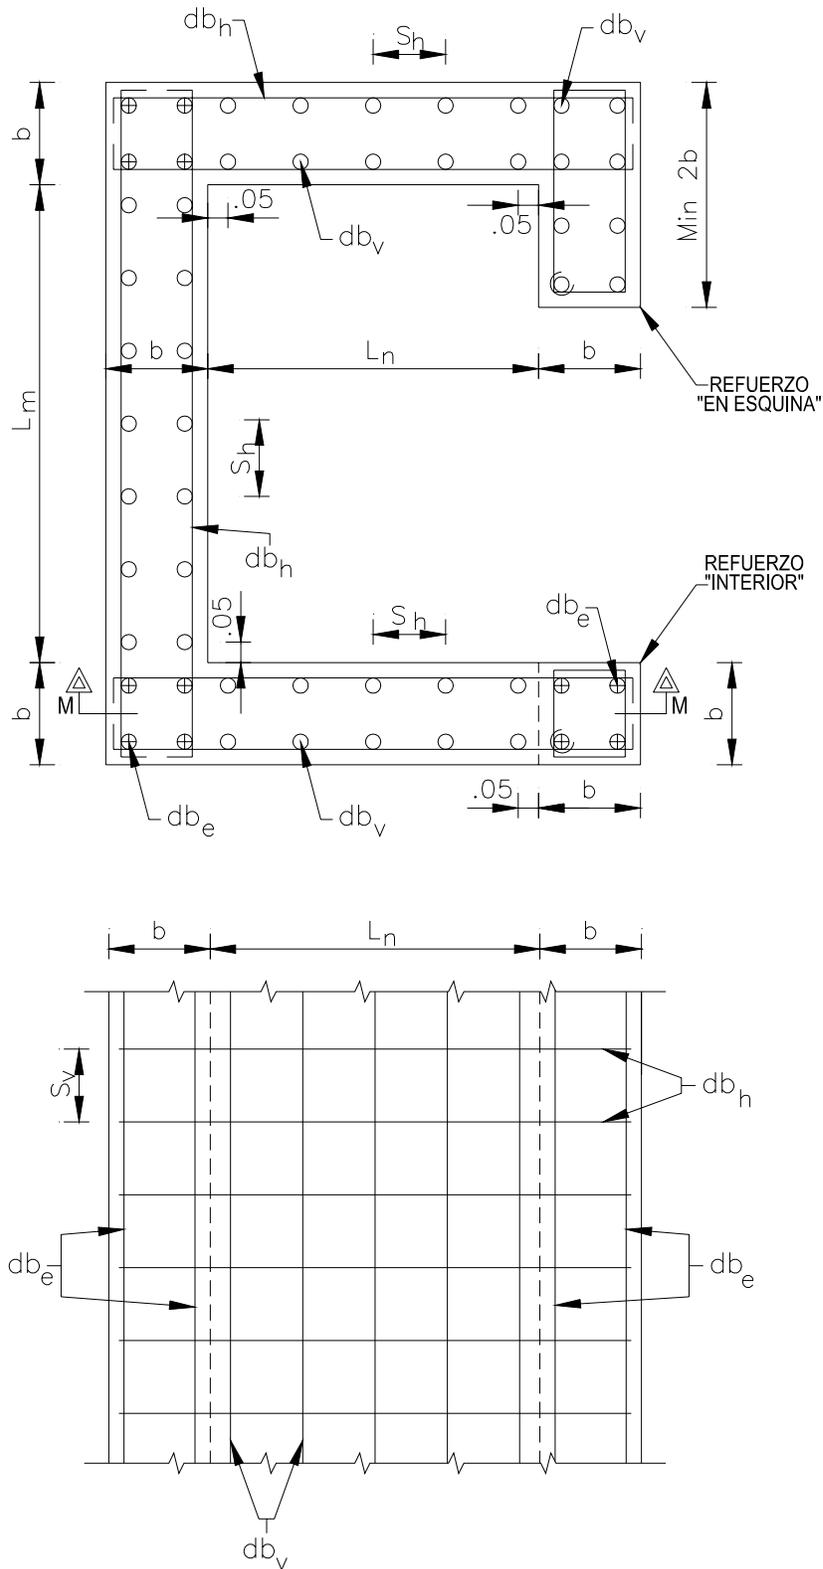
Muros de cortante, vista en planta y sección M-M.
